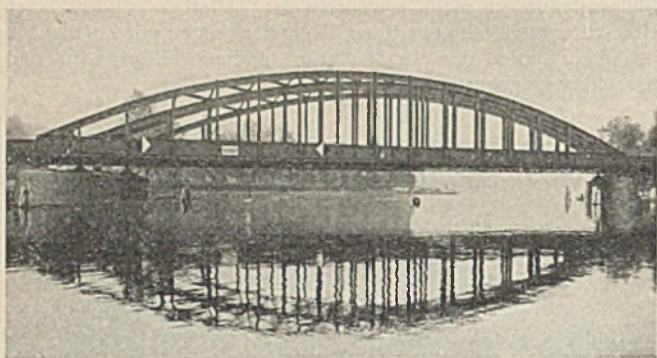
Eisenbahnbrücke über die Havel bei Potsdam.
